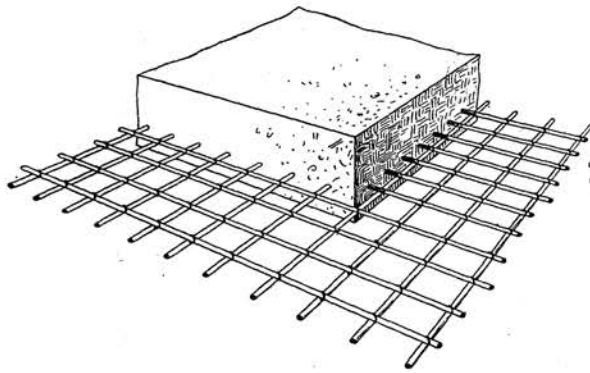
Losa de hormigón armado, sistema *Monier*.
